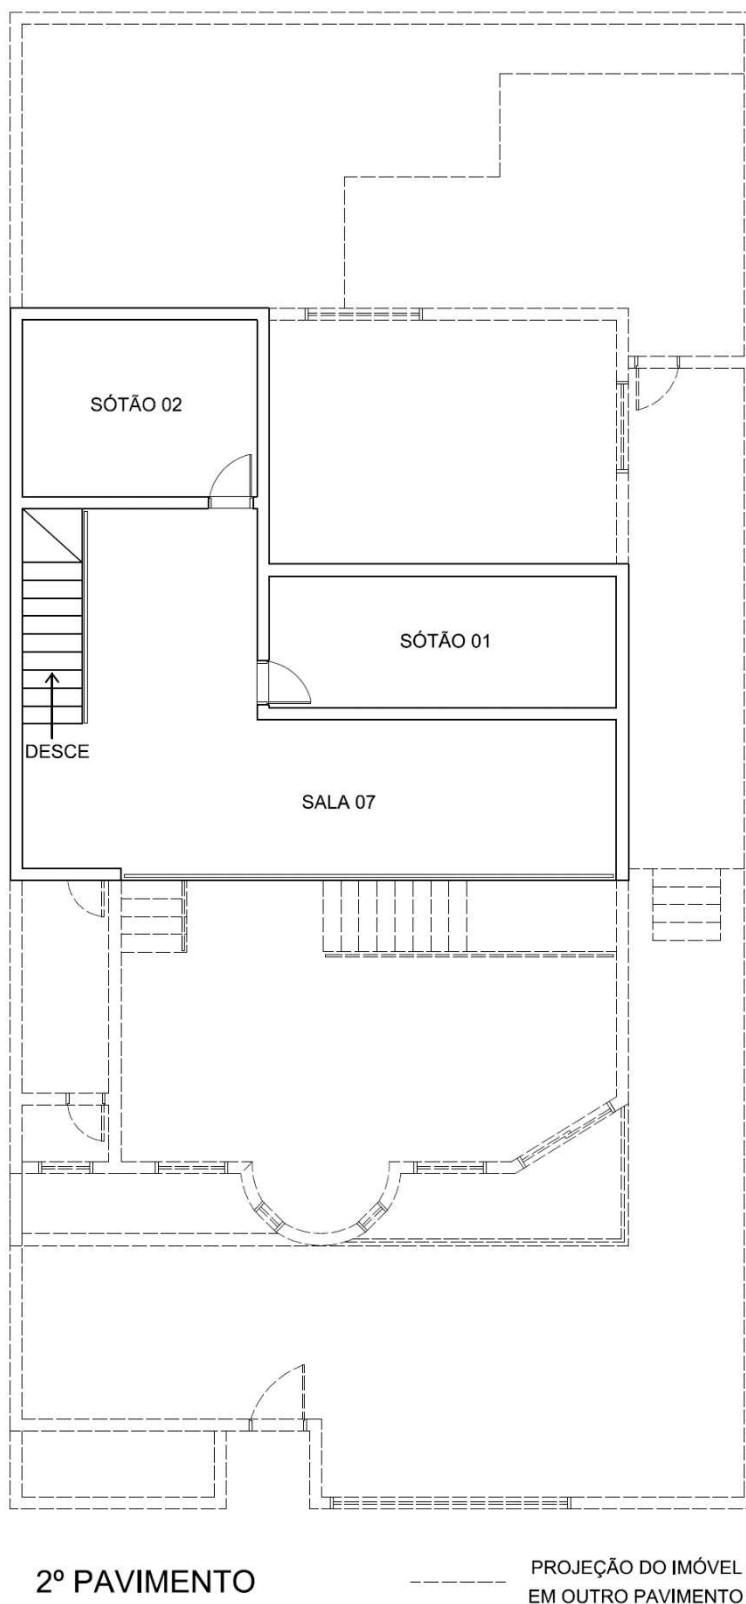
Croqui do 2º pavimento (sem escala) – Fonte: Autor
